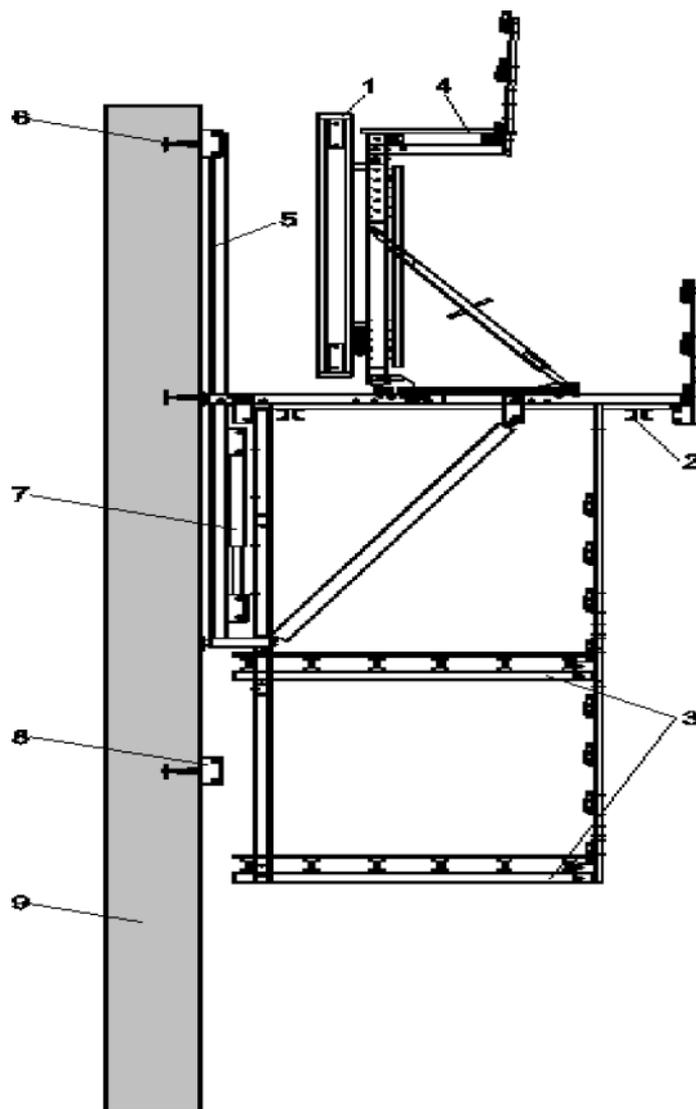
Схема самоподъемной опалубки 1 – наружная опалубочная панель; 2 – рабочие подмости; 3 – нижние подмости; 4 – подмости для бетонирования; 5 – направляющие балки; 6 – анкер; 7 – гидравлический домкрат; 8 – навесной башмак с гравитационным механизмом; 9 – монолитная стена
